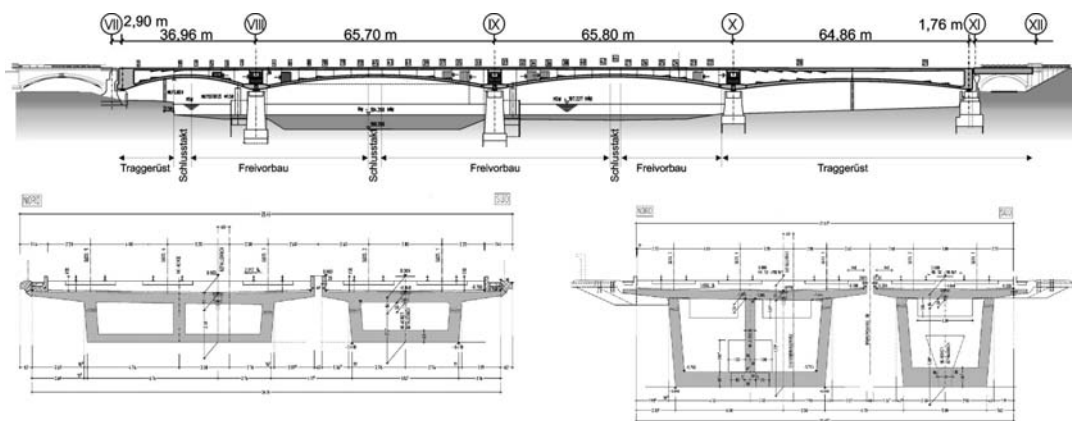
Variante Spannbeton-Balkenbrücke über 8 Felder
